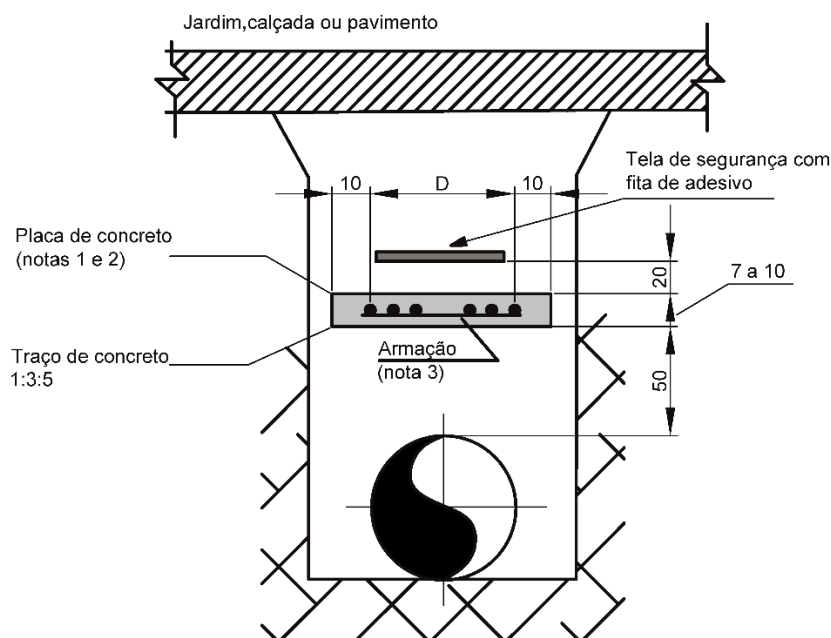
Instalação da tela de segurança (com fita/faixa de aviso) e da placa de concreto.
